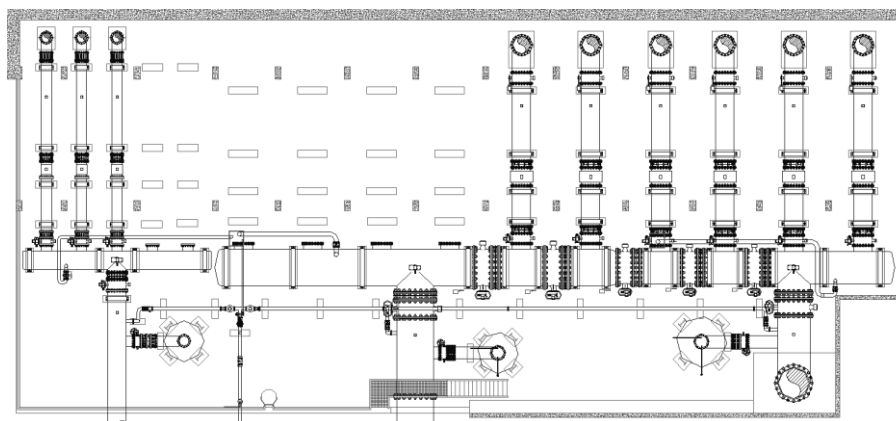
Planta dos coletores e caudalímetros da estação elevatória da ETA de Lever.
